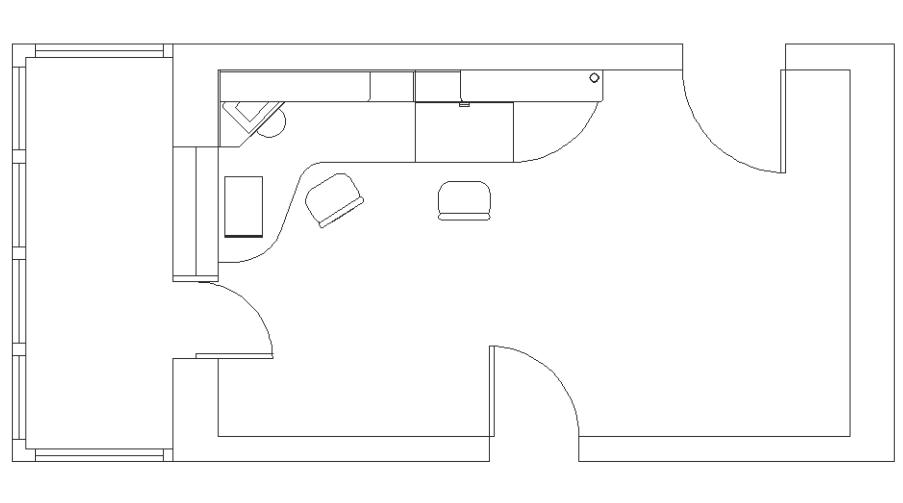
▼ Обновленный главный чертеж с измененными объектами файла внешней ссылки
